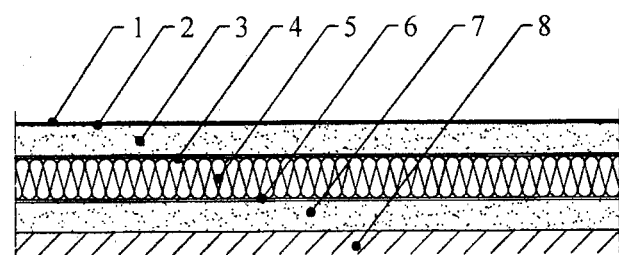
Pardoseli cu strat de uzură din covor și dale din mase plastice, fără suport textil, pe șapă din mortar de ciment fin drișcuită cu izolare fonică
